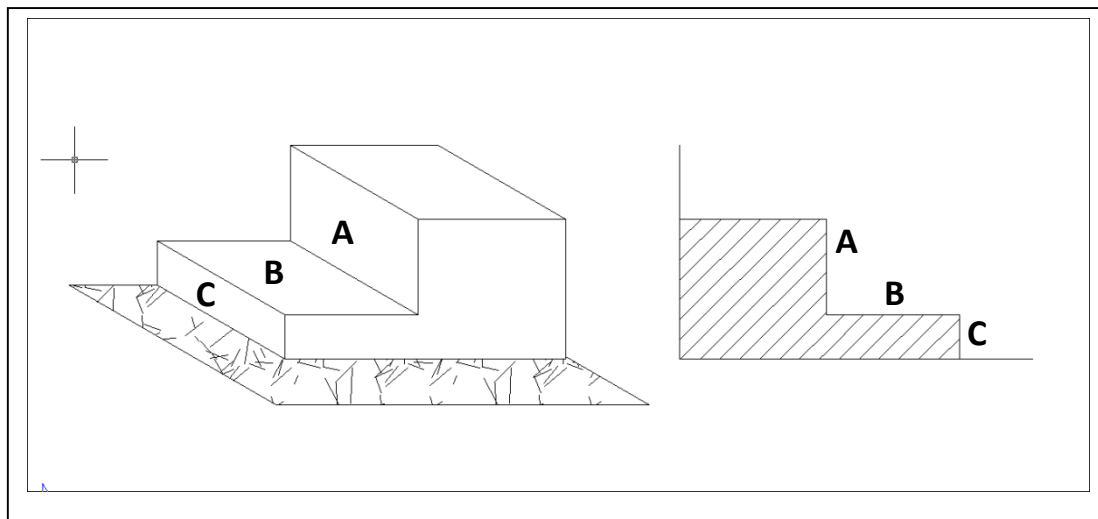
PORZIONE LATERALE DELLA FONDAZIONE
